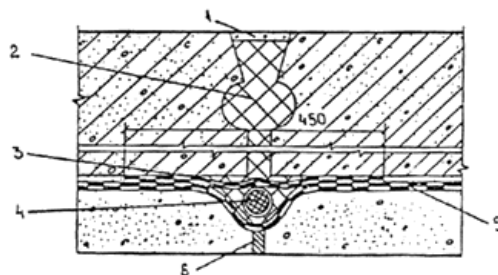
Конструкция гидроизоляции деформационного шва между плитами сборного лотка
